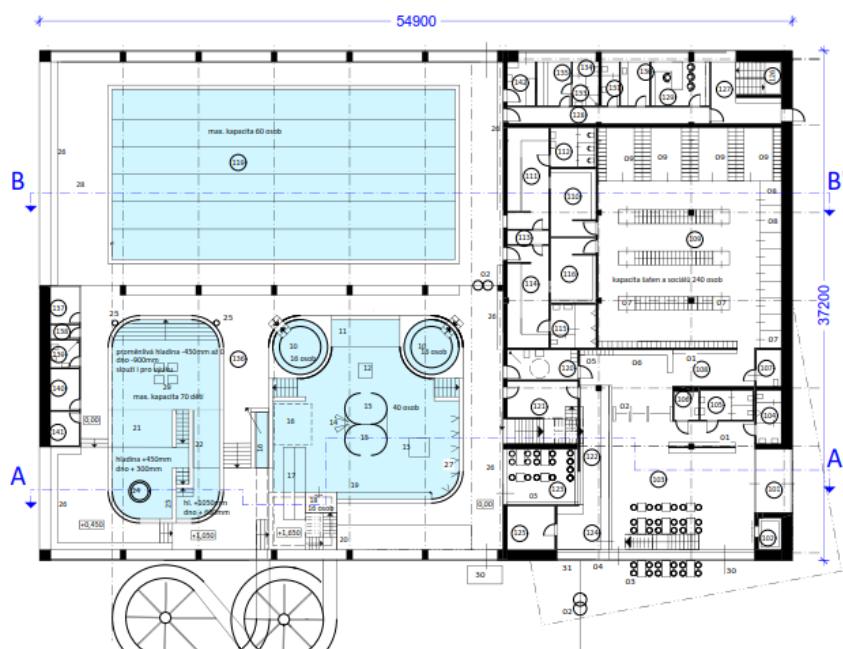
Půdorys 1.PP – 50 m bazén (zdroj: Šumavaplan projekt s.r.o.)
